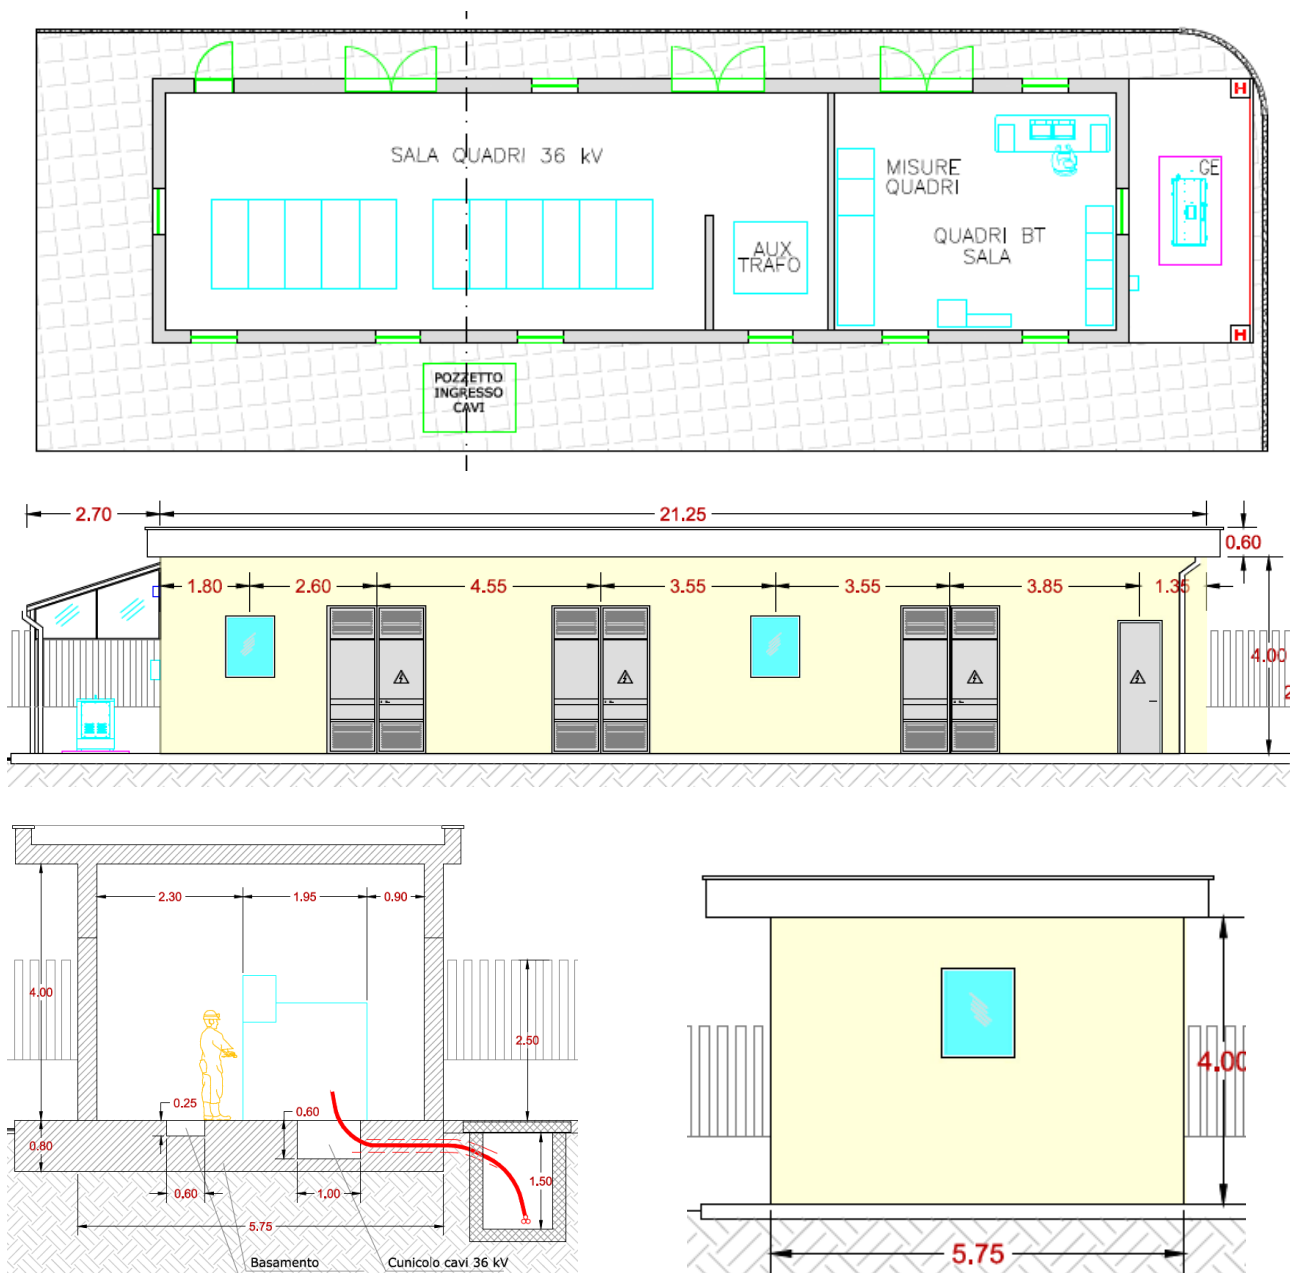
viste edificio di comando – planimetria, prospetti, sezione
